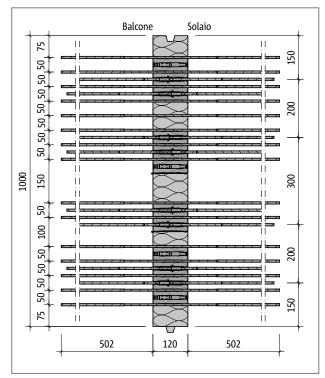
Schöck Isokorb® tipo KXT65: pianta del prodotto
